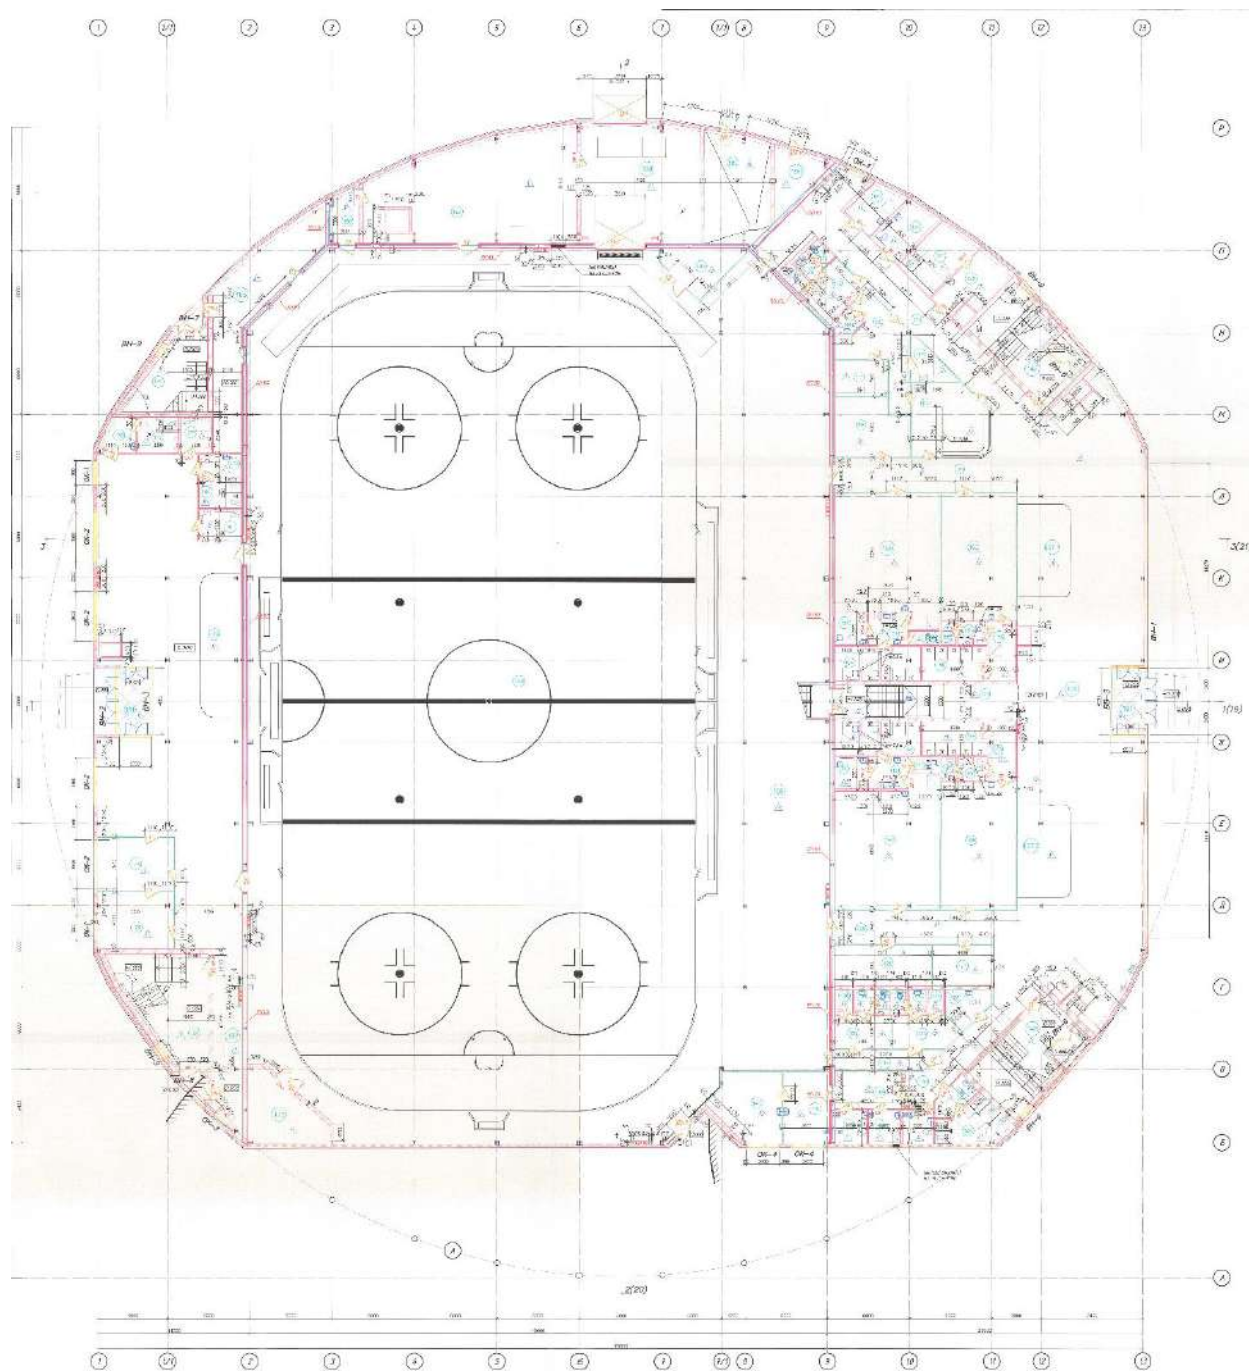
Крытая спортивная арена. План 1 этажа.
